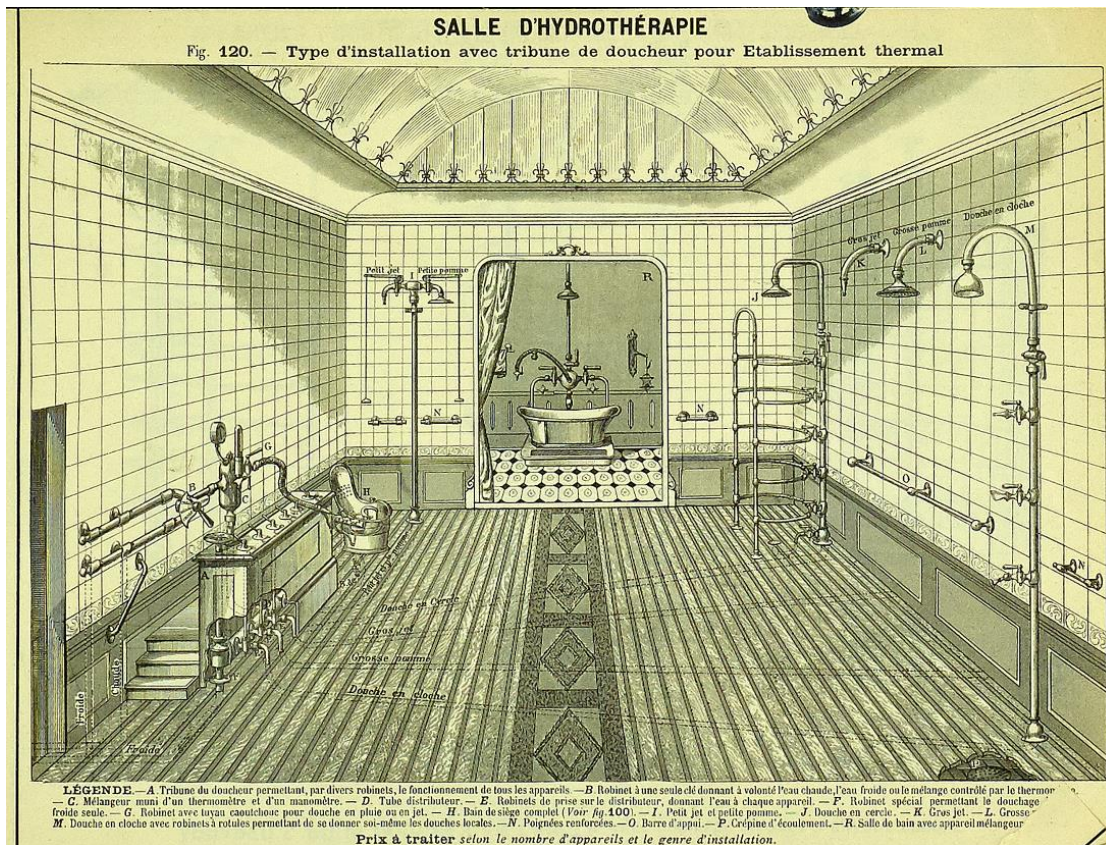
Exemple de salle d'hydrothérapie, type d'installation avec tribune de douches pour établissement thermal, gravure industrielle sur papier, extrait de document publicitaire transmis par un entrepreneur à la ville de Tourcoing.
